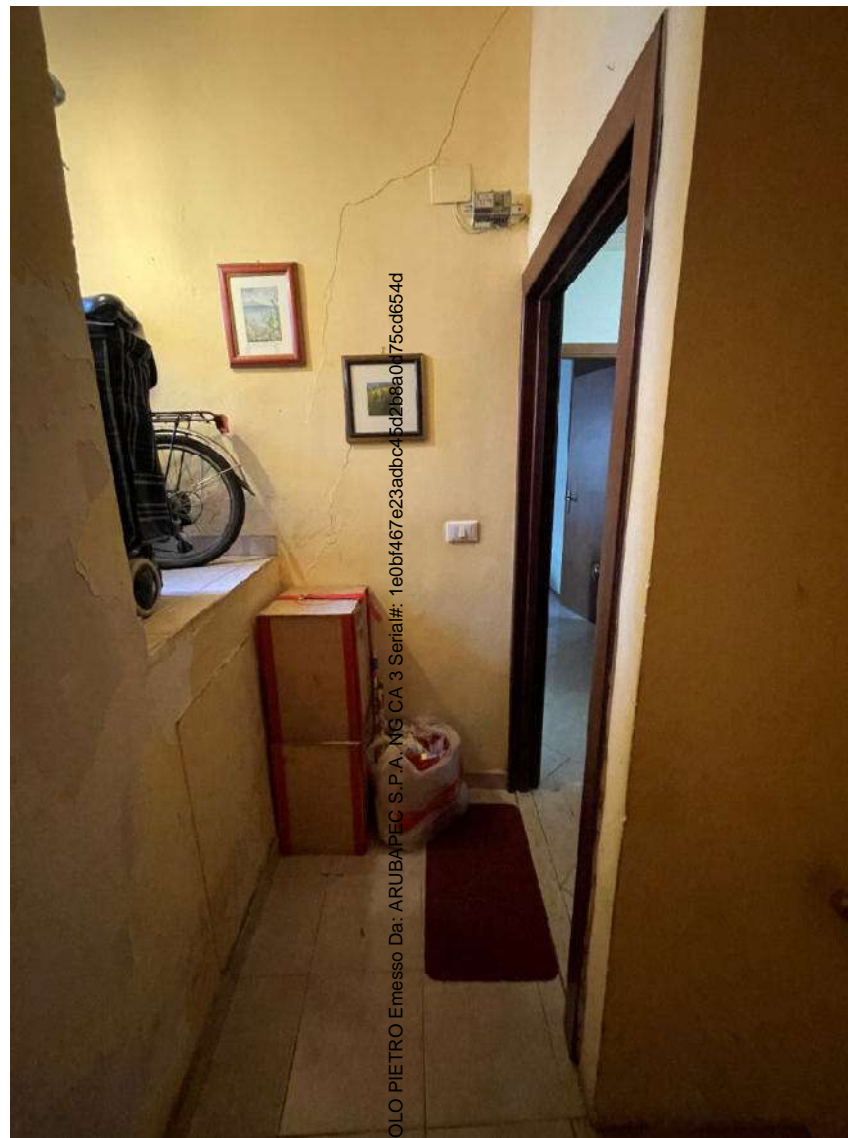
Pianerottolo 1° piano con ingresso all'immobile
